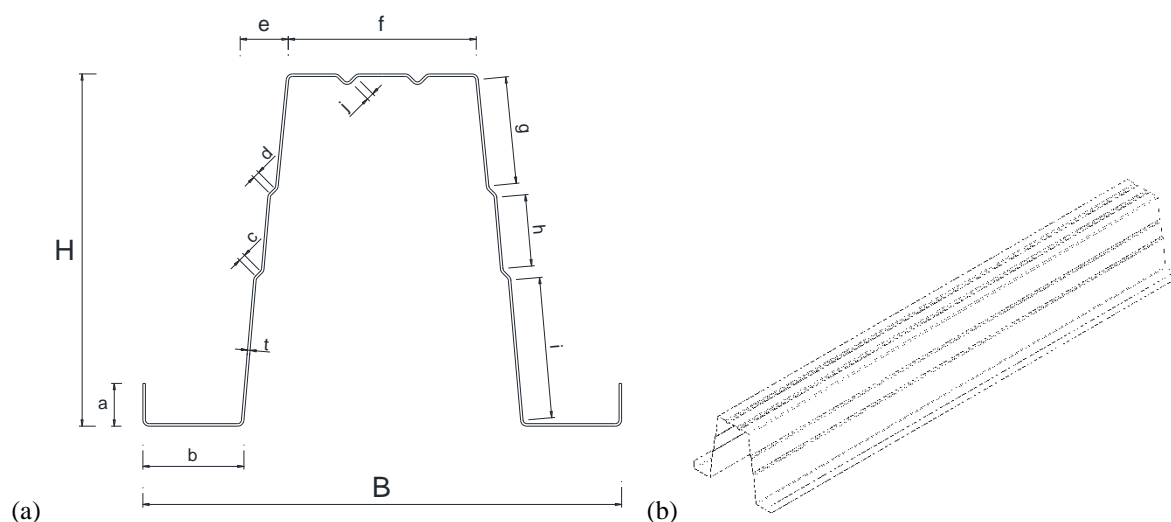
Perfil Ω em estudo: (a) secção transversal e (b) perfil longitudinal.
